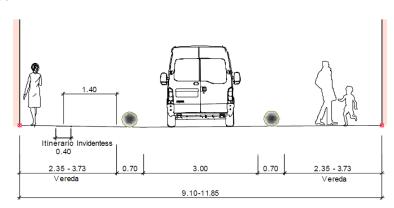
Detalle planta propuesta peatonalización Jr. Pizarro e Independencia
